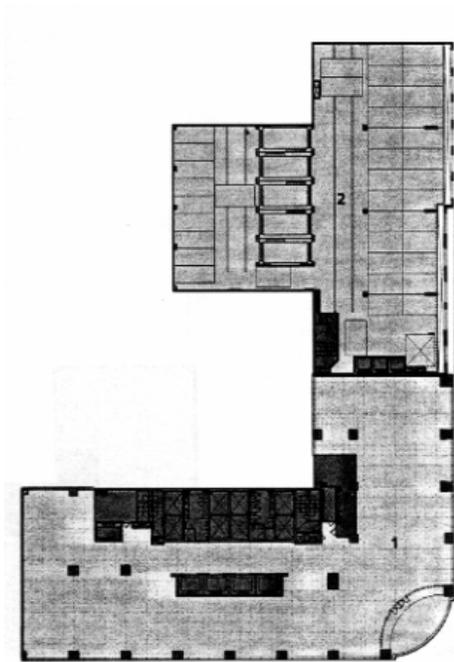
Torre Almirante – Planta Baixa - 6º pavimento (1= escritório e 2 = estacionamento)
